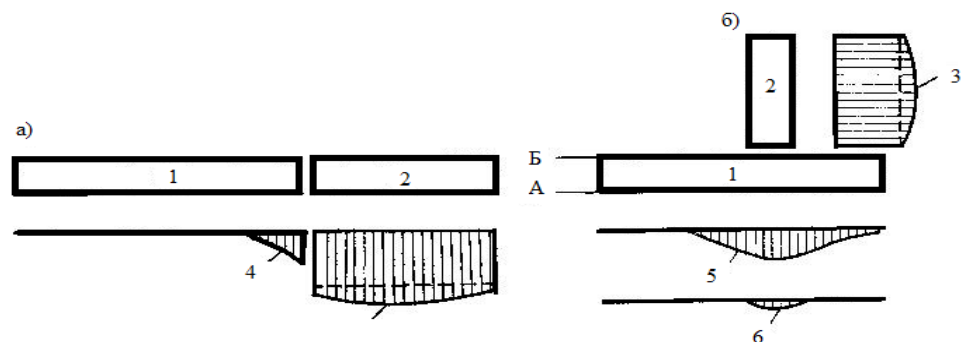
Розвиток додаткових усадок при різному влаштуванні примикань будівель: а-до торця; б-до поздовжньої стіни; 1-будівля ранньої забудови; 2 - нова споруда; 3-епюра усадки нової будівлі; 4-епюра додаткової усадки старої будівлі; б-те ж, по осі Б; б-те ж, по осі А.
